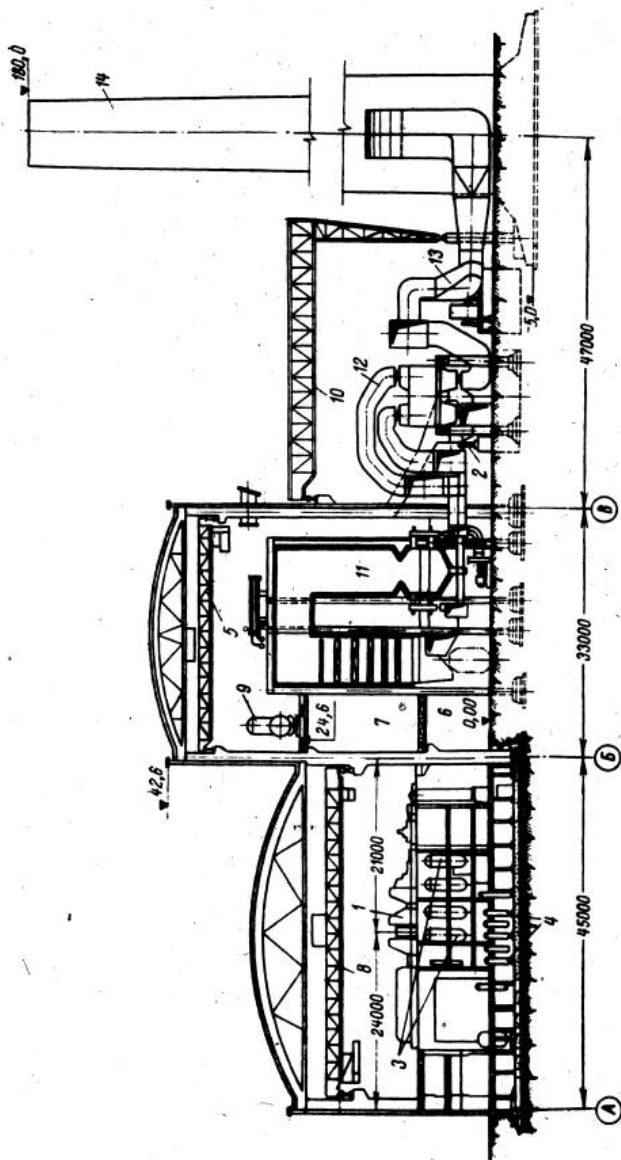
Поперечный разрез главного корпуса газомазутной ГЭС-2400 с блоками 300 кВт:
